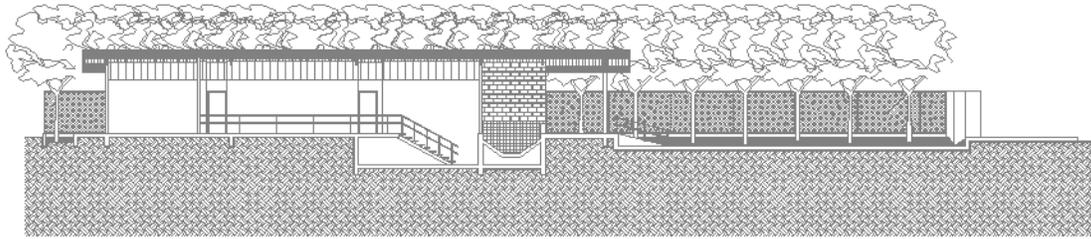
Corte Longitudinal Fachada Posterior.
